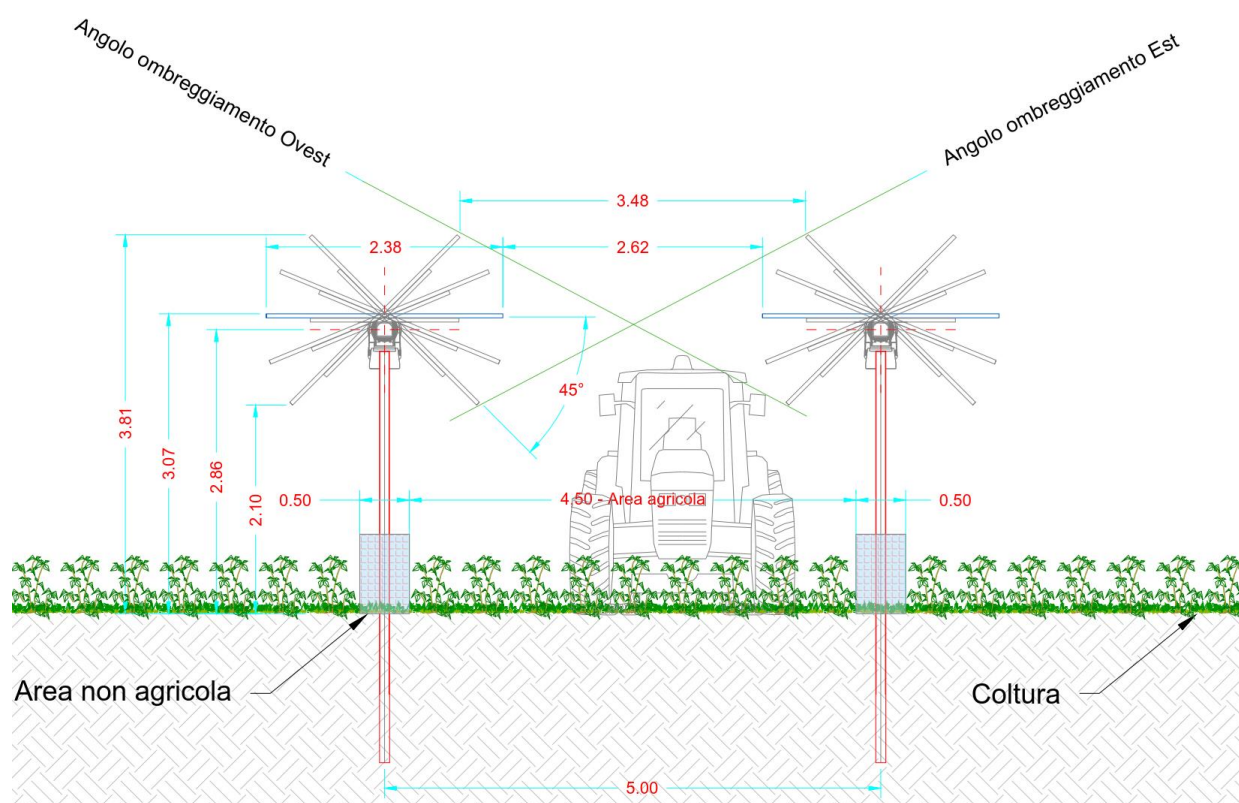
Sezione trasversale tipologica struttura Tracker – Area 05
